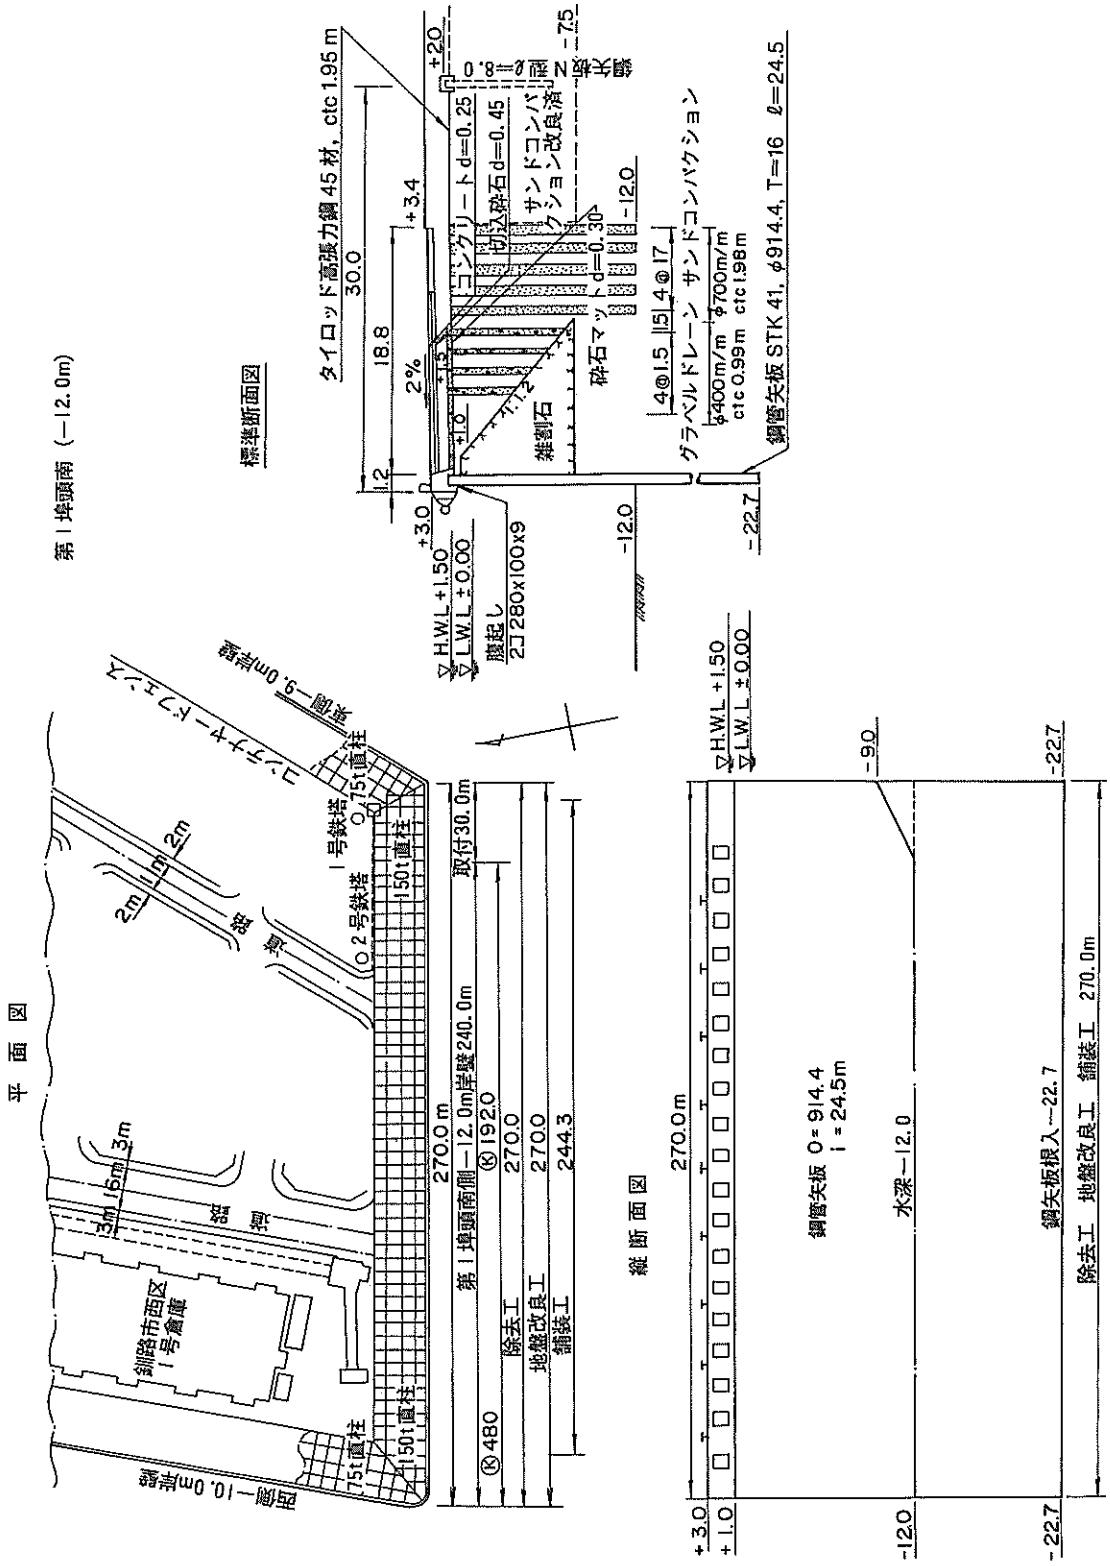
平面図・縦断面図・標準断面図（第一埠頭地区、⑥南側岸壁（-12.0m））⁵⁾
